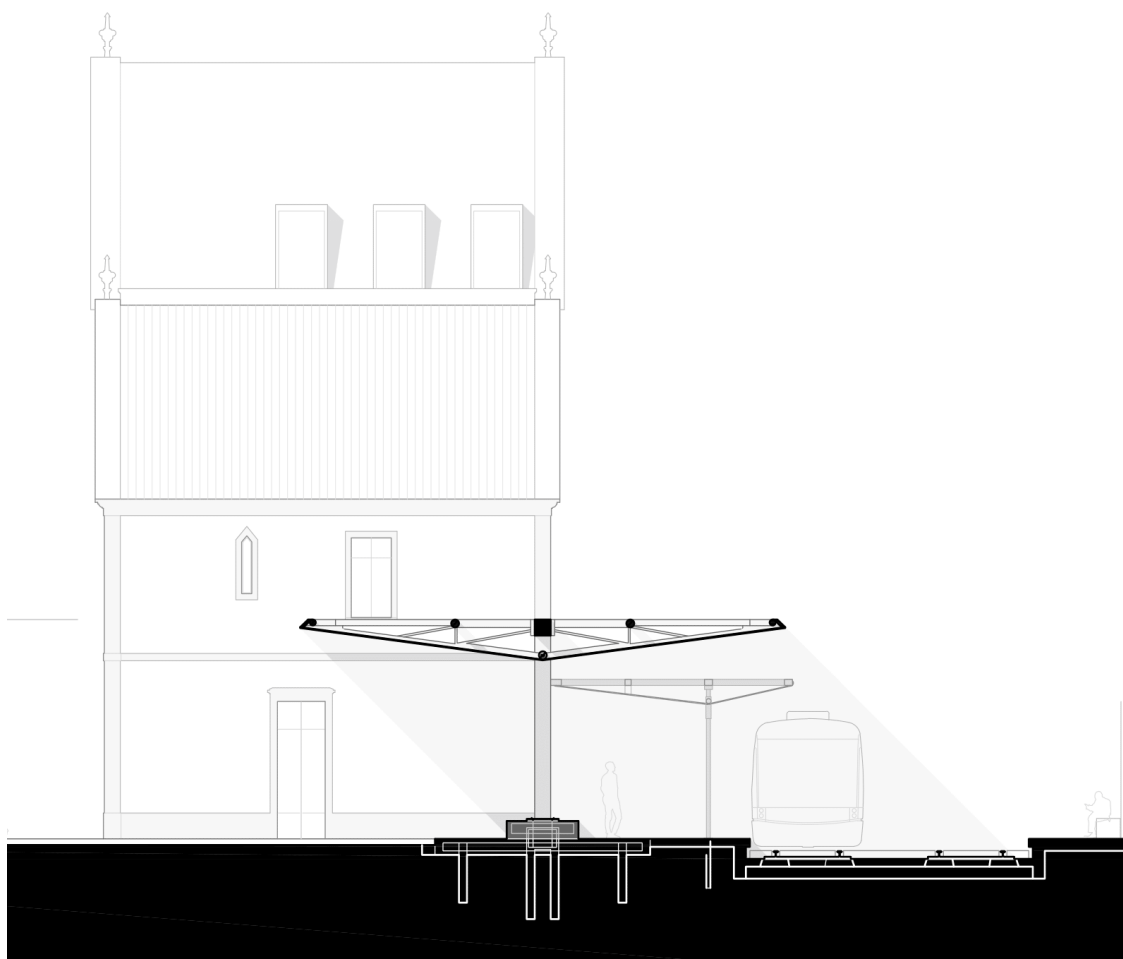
Secção transversal sobre a cobertura do terminal de autocarros
